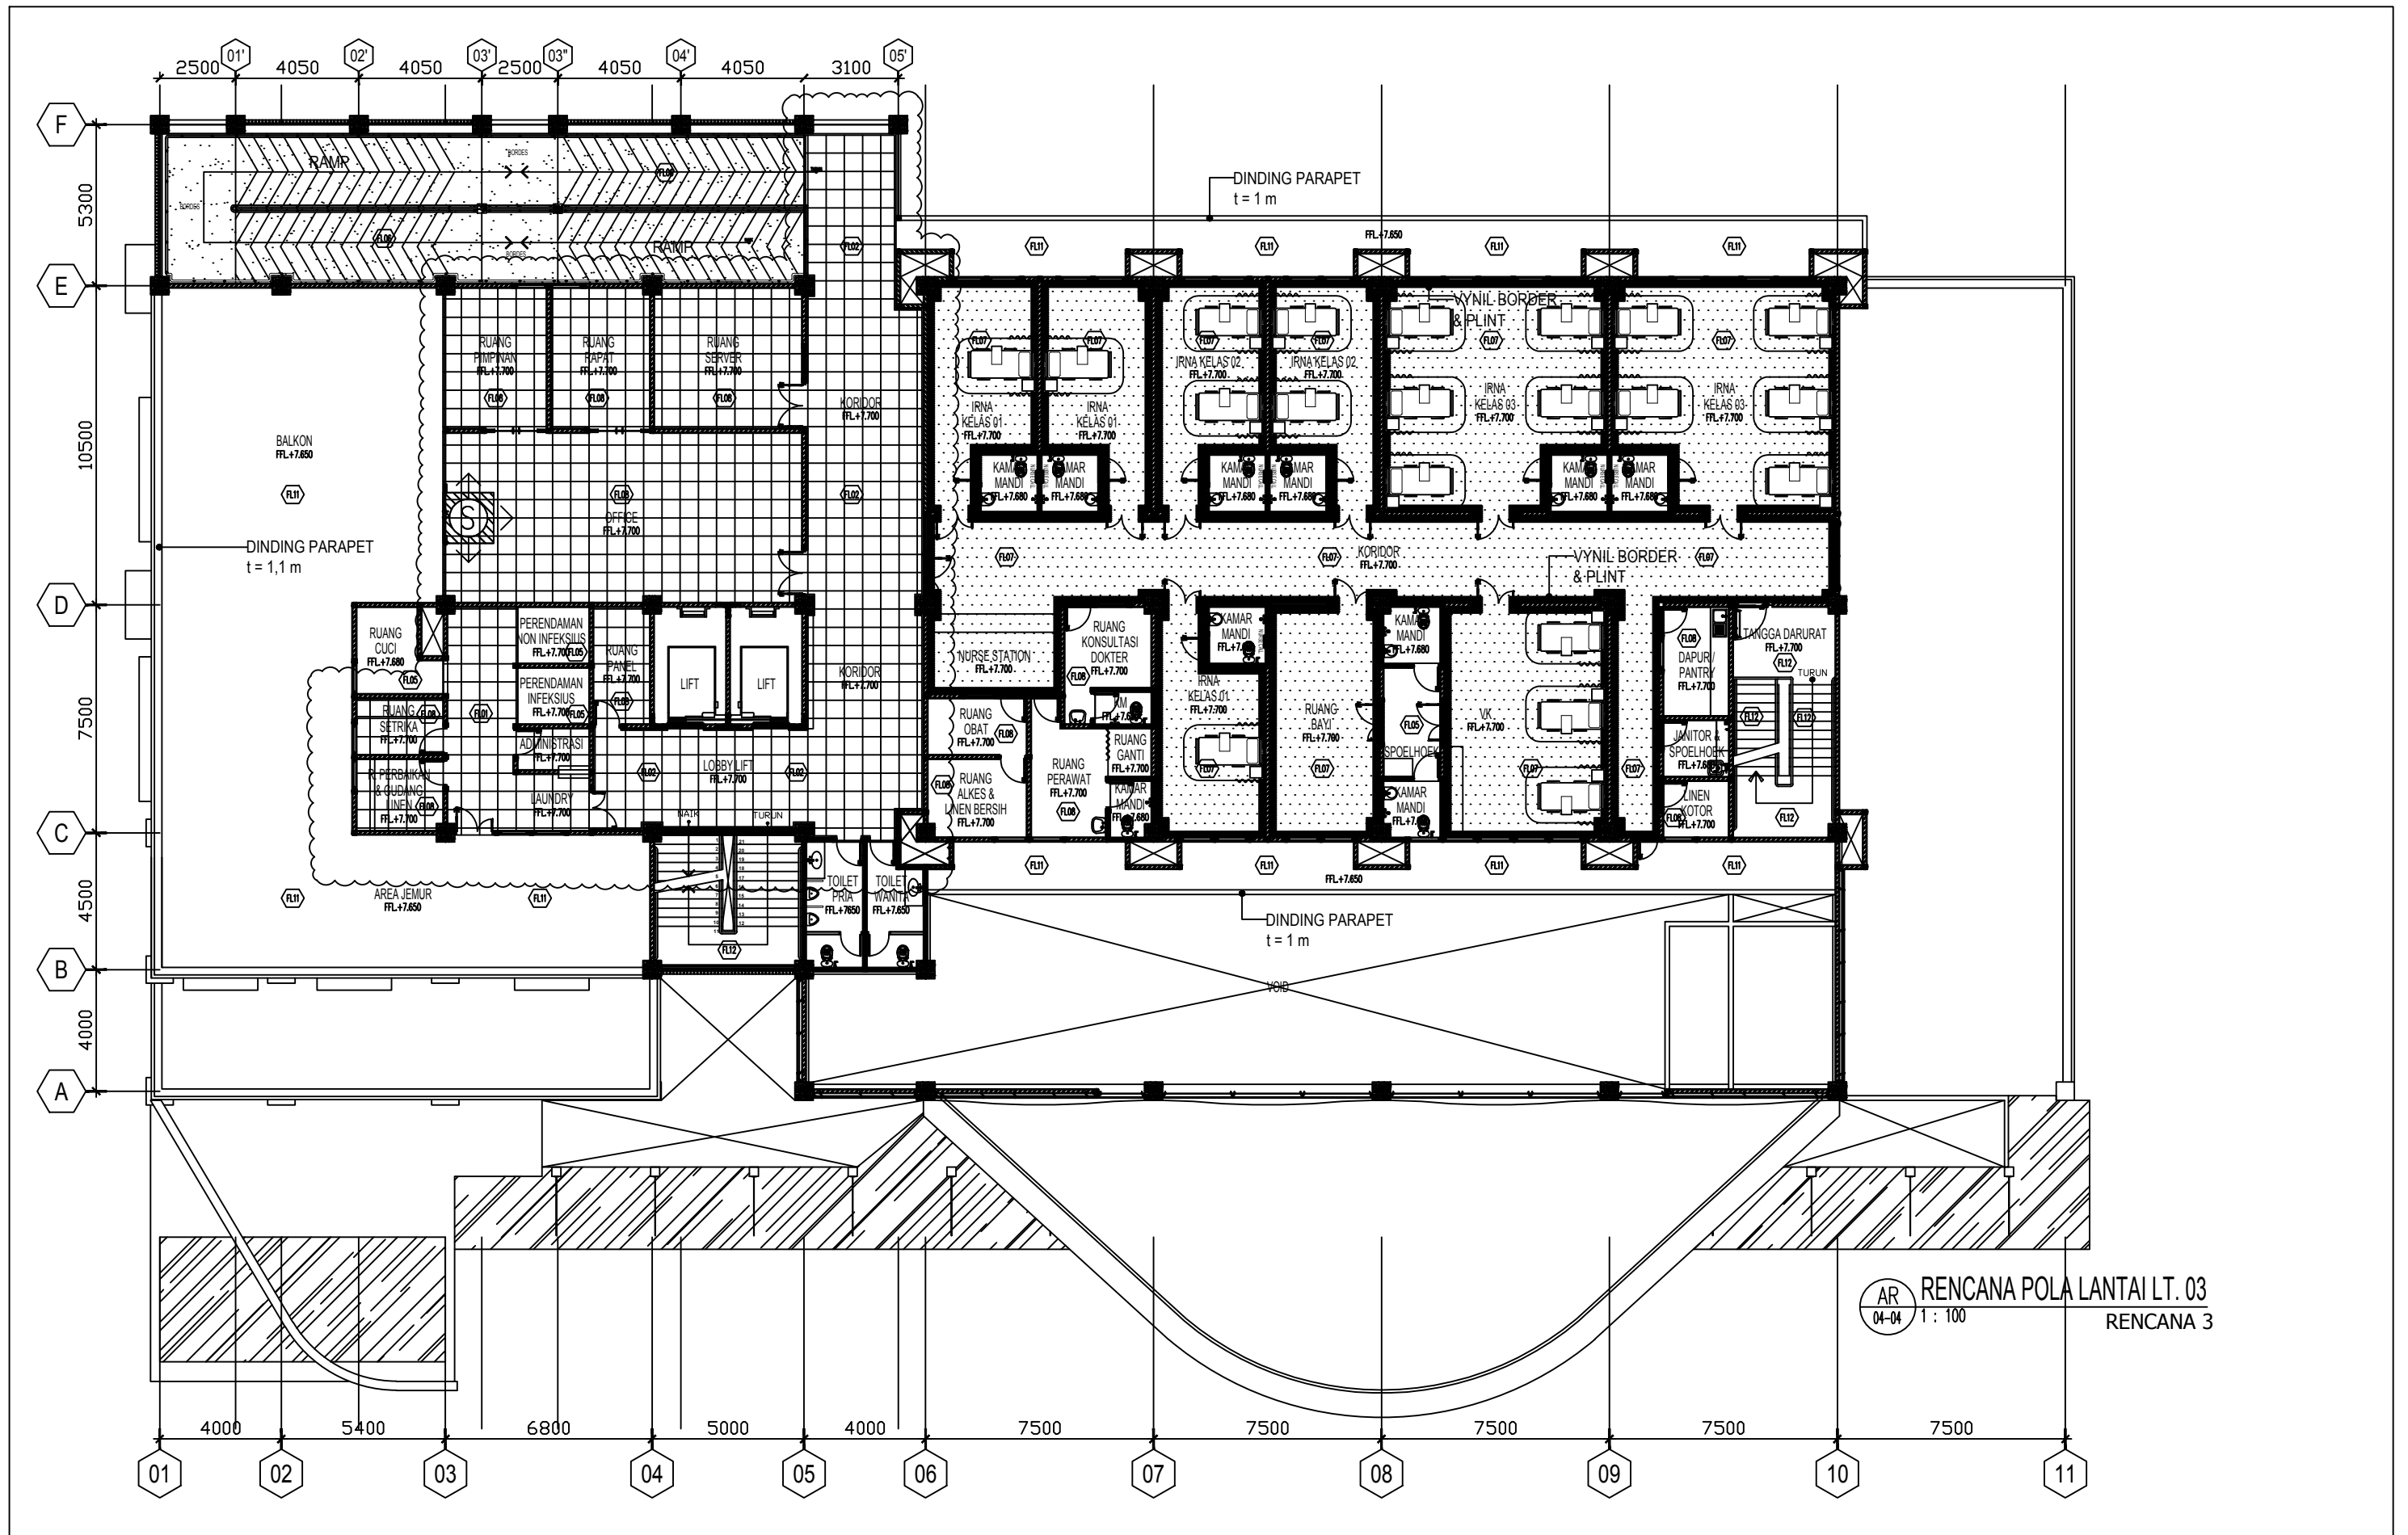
Denah Pola Keramik Lantai 3 (versi 1)
